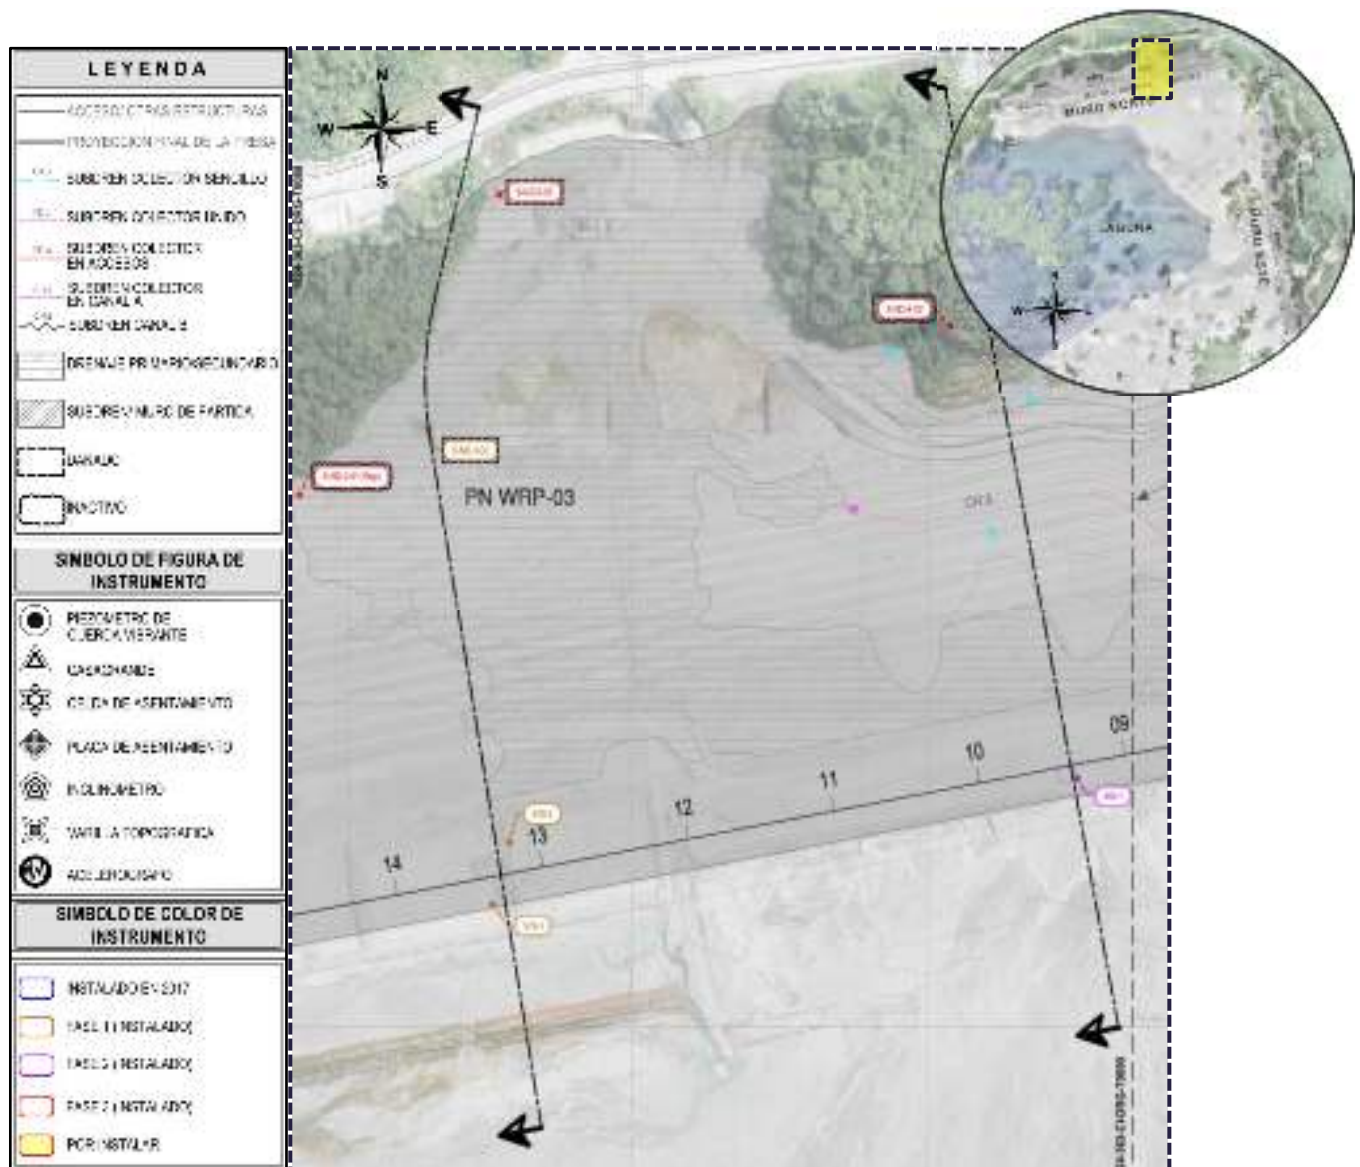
Vista de Planta en el Muro Norte Sector 1-2 con las Celdas de Asentamiento
